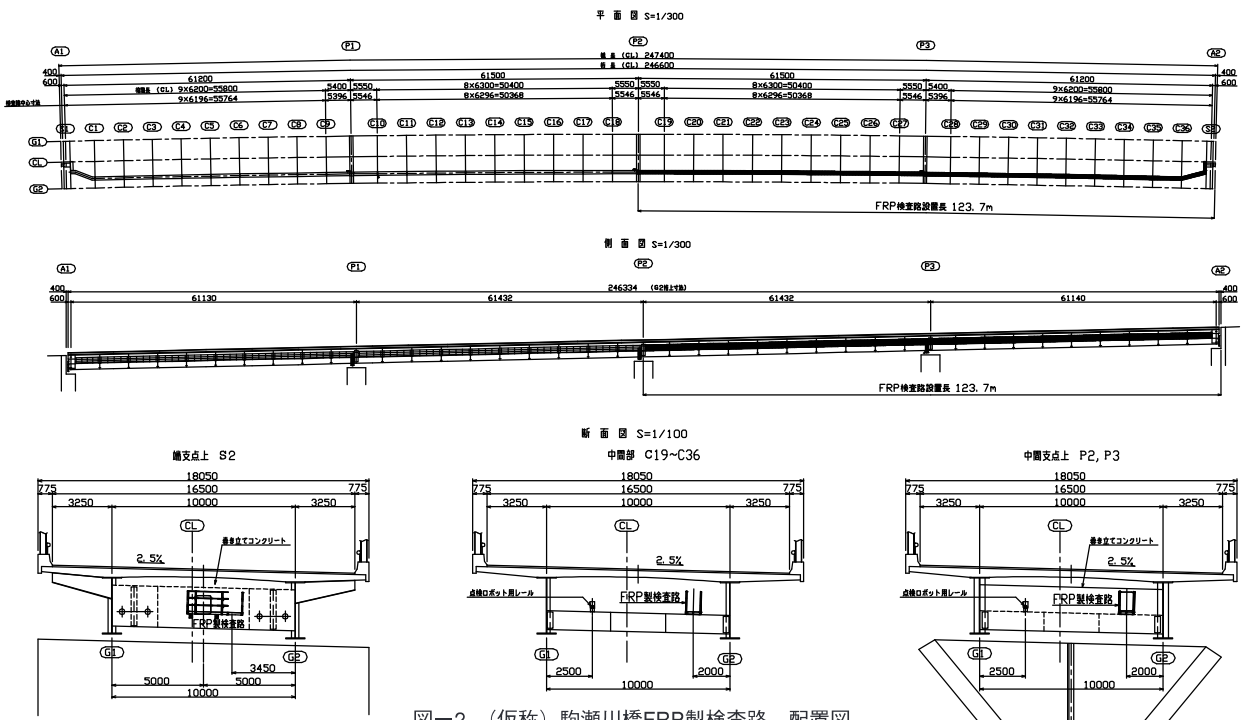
（仮称）駒瀬川橋FRP製検査路 配置図
